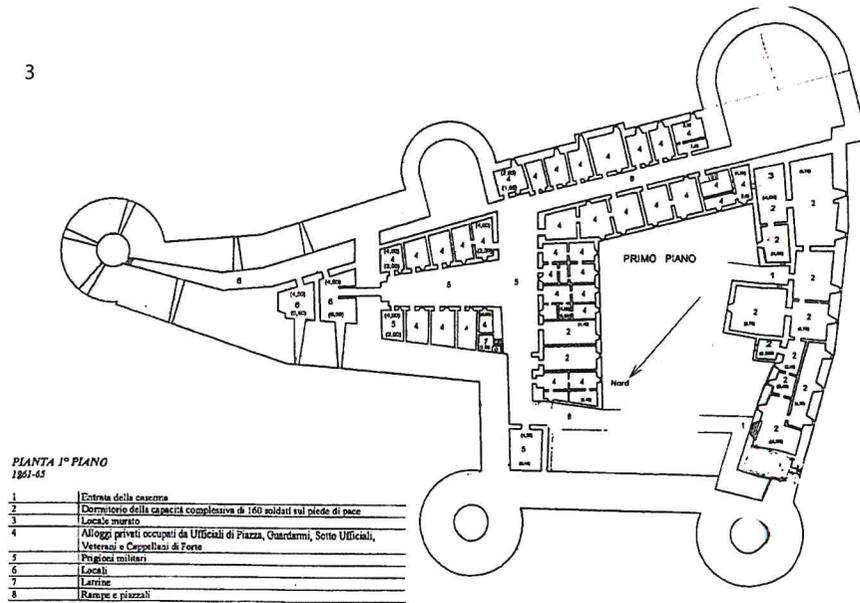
Planimetria del 1861 del piano degli alloggi del Castello.
